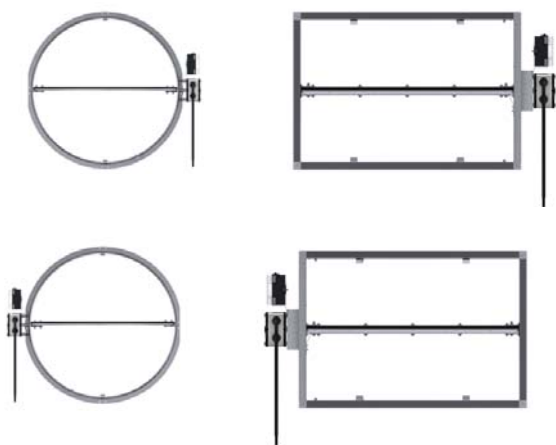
Instalace klapky DKIR-1 na/do potrubí procházejícího vertikální podpůrnou konstrukcí (stěnou)
